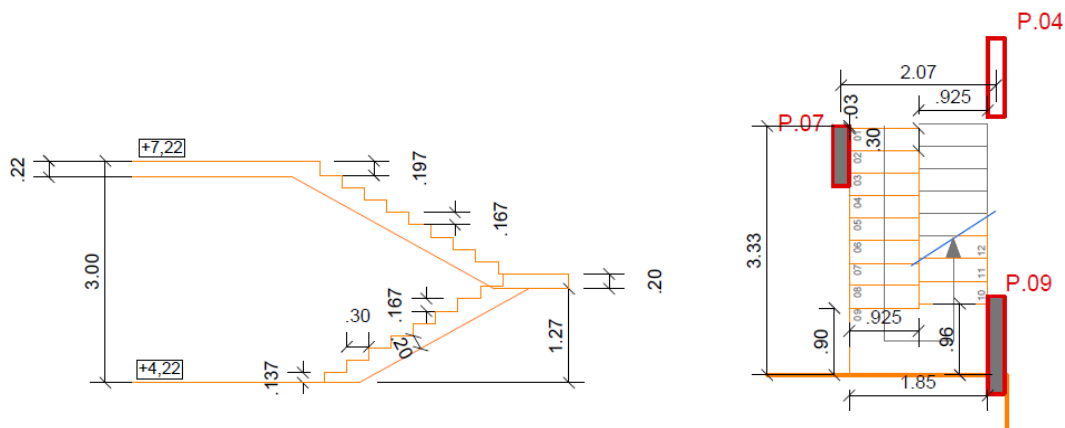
Planta e corte da escada do lote 6.5, piso -3 e -2.
